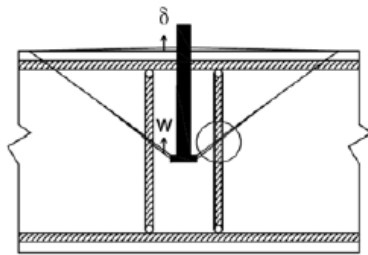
Varões com cabeça soldada “headed studs” - W. Berger, R. Eligehausen, J. Hofmann [5]
